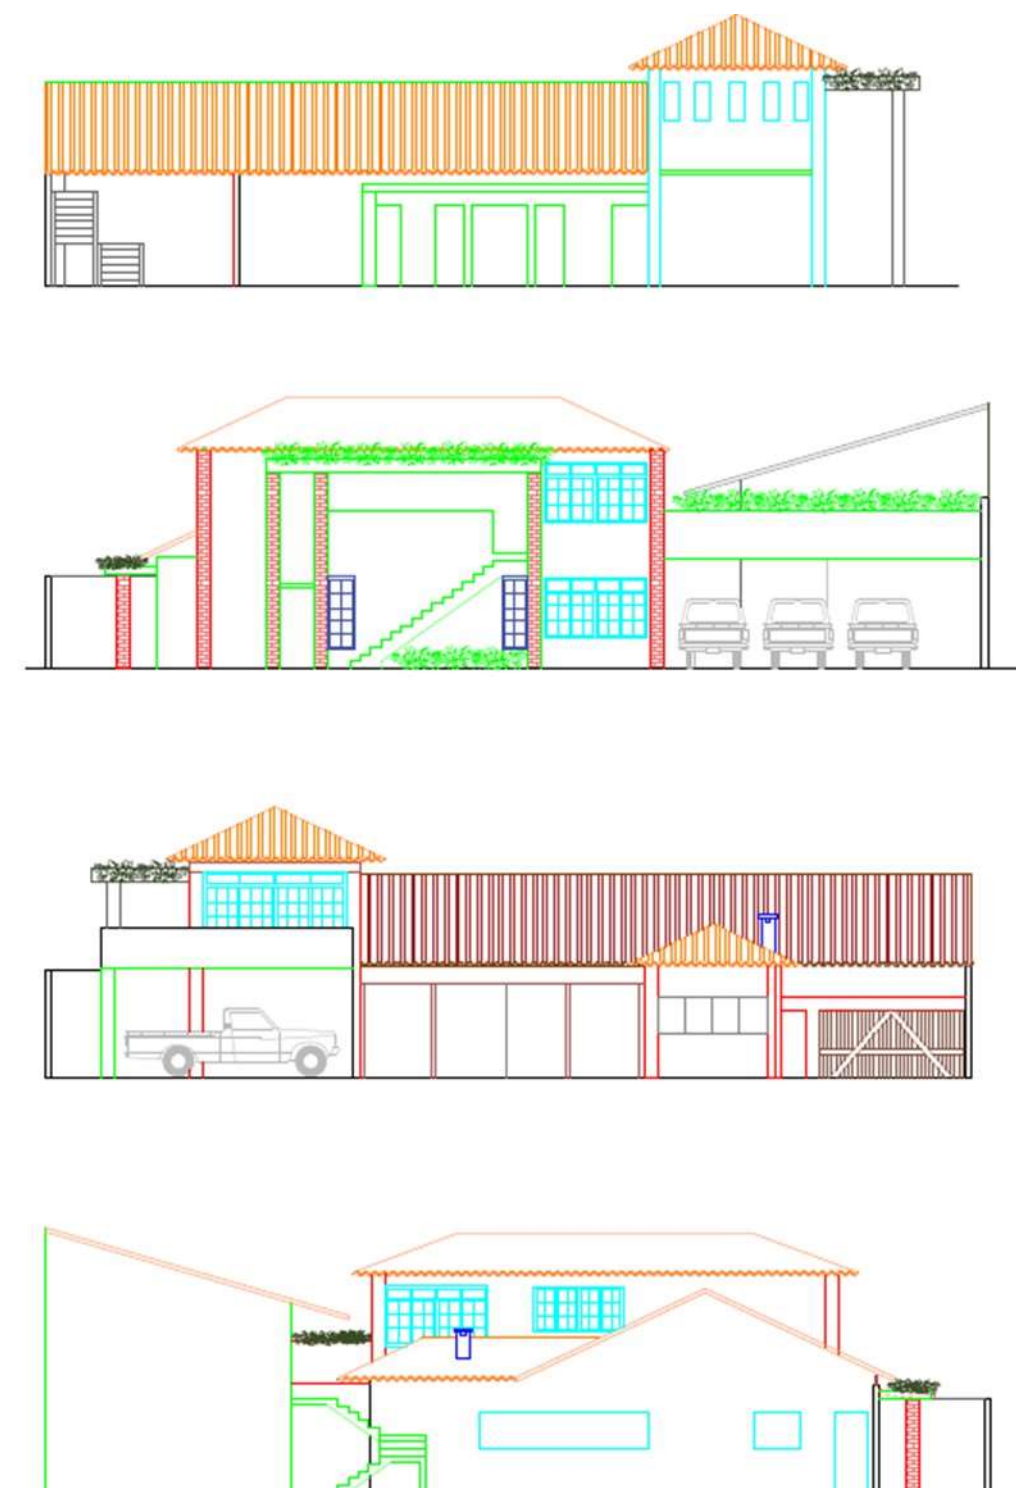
novas fachadas propostas. De cima para baixo: S. L. N e O.
